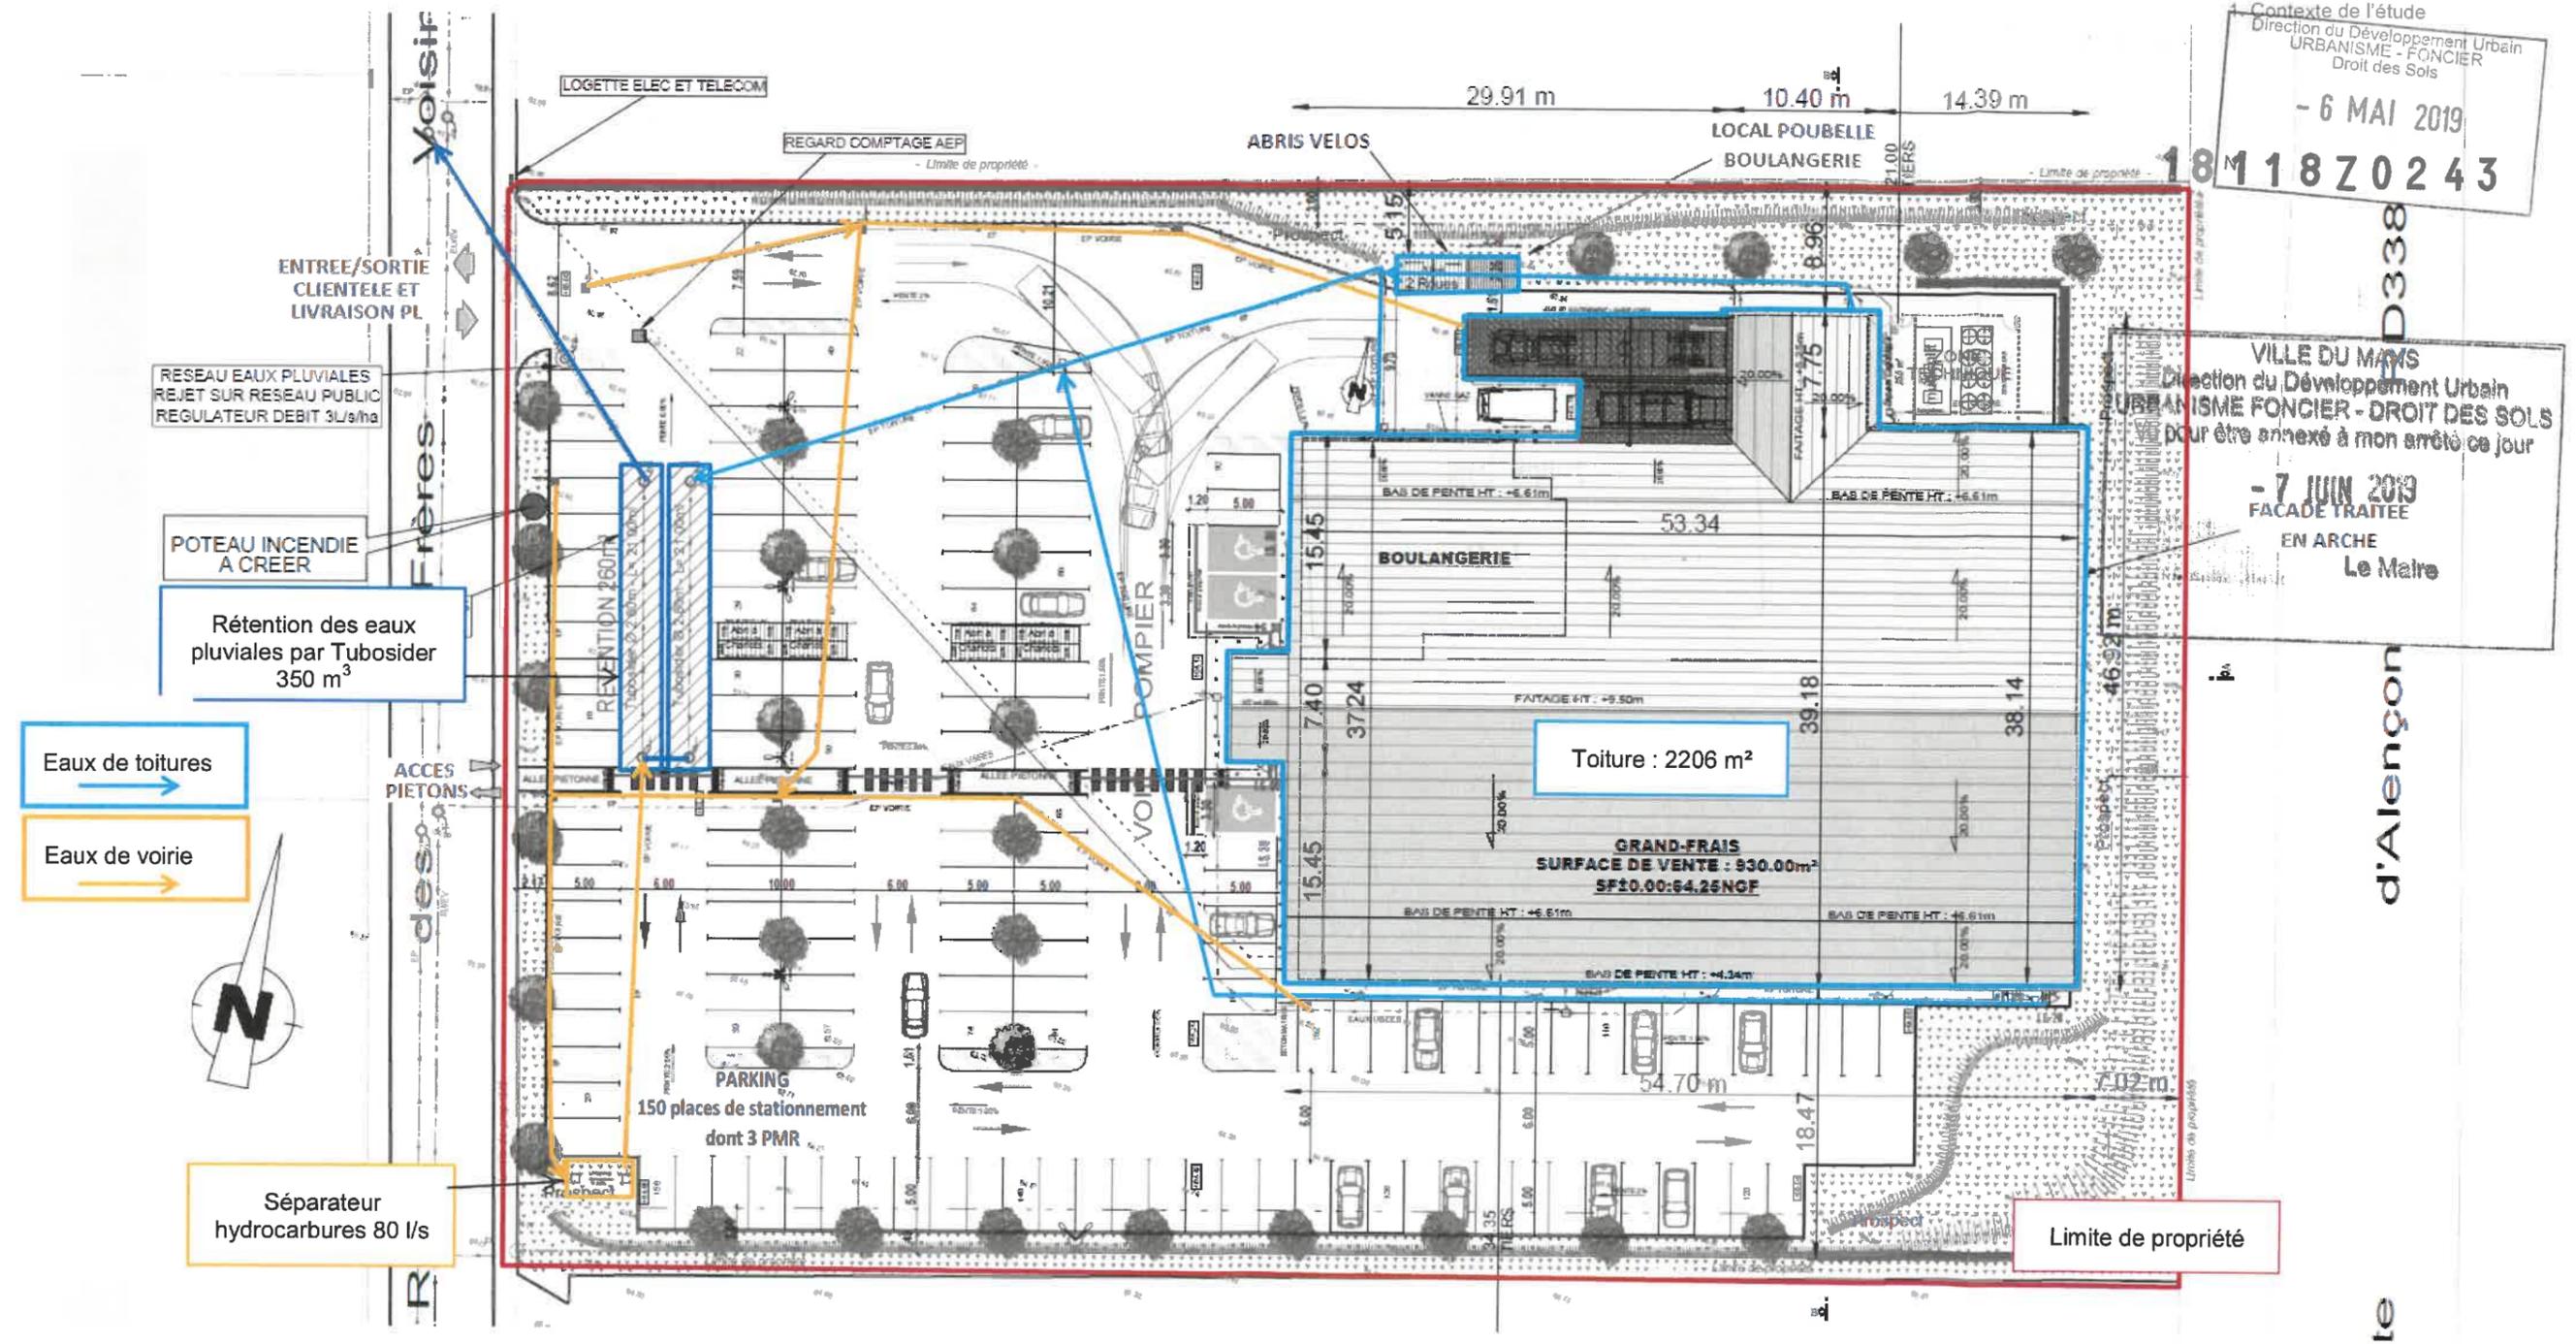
Localisation du site à l'étude (source : permis de construire)
